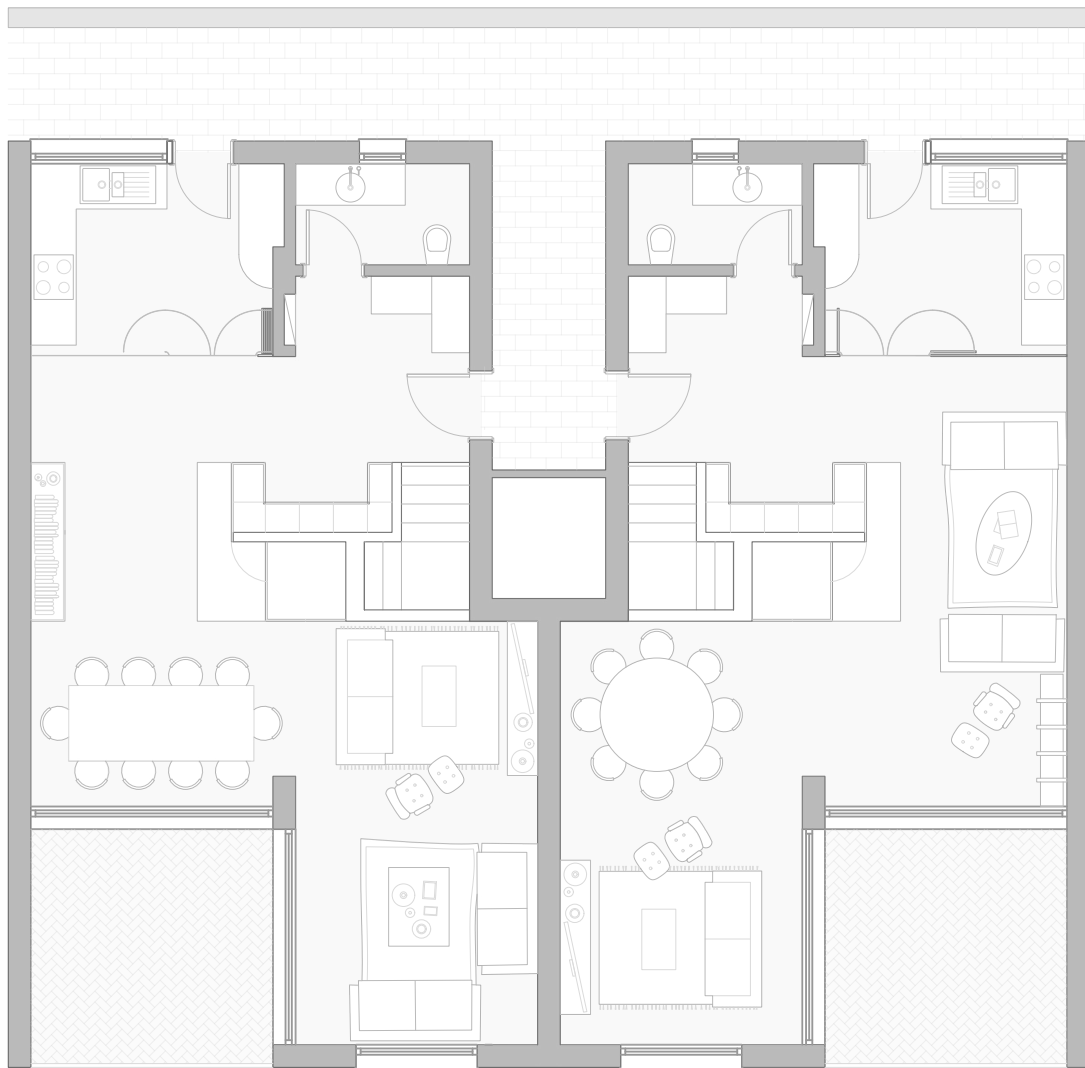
Planta T4 2x2 Piso Inferior 1:100
